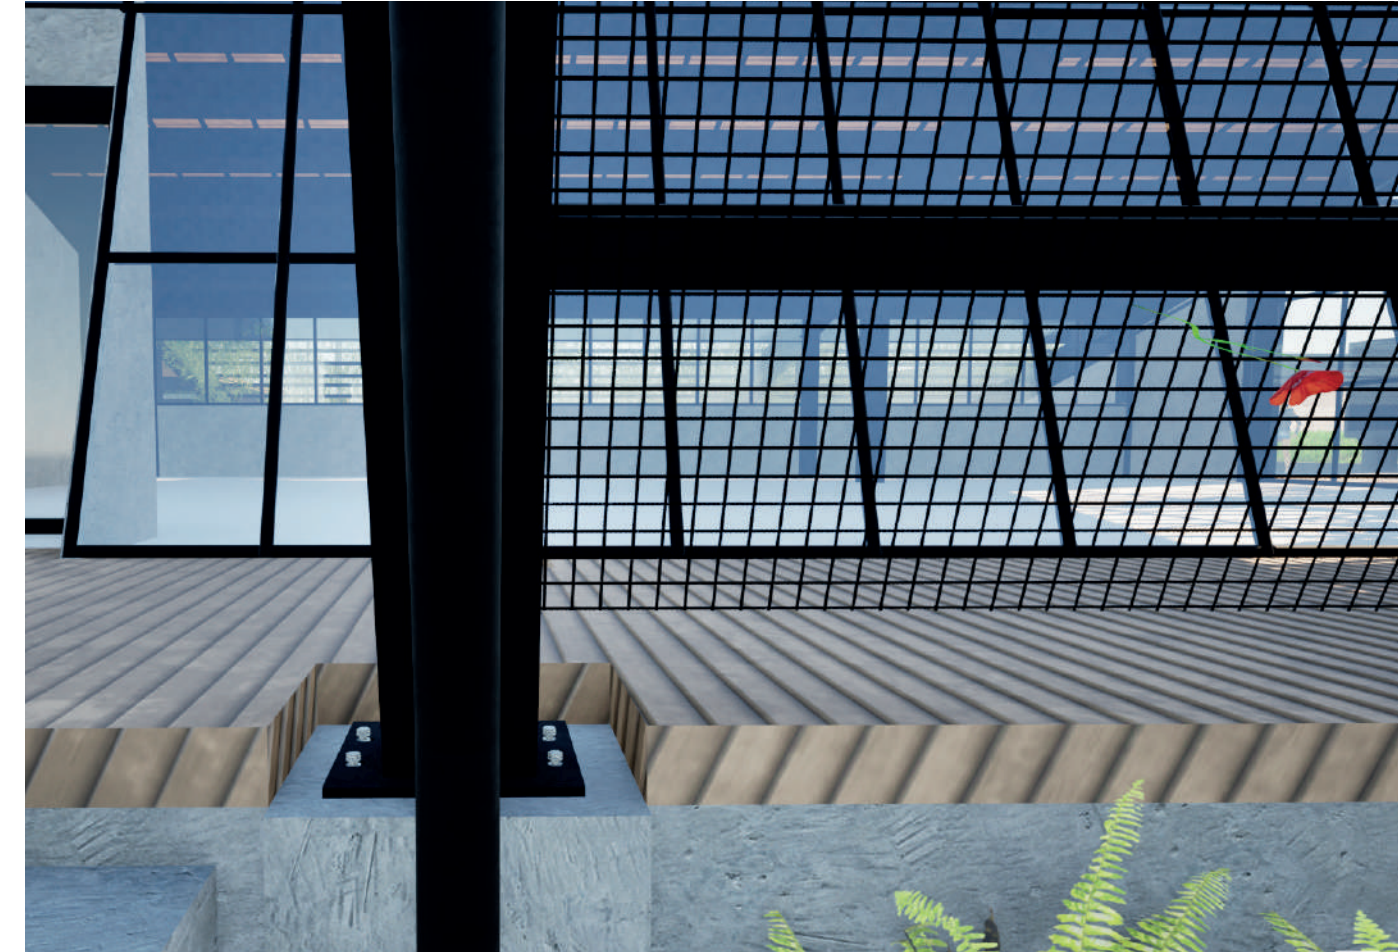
Diagrama conjunto de estructura. Fuente: propia.
